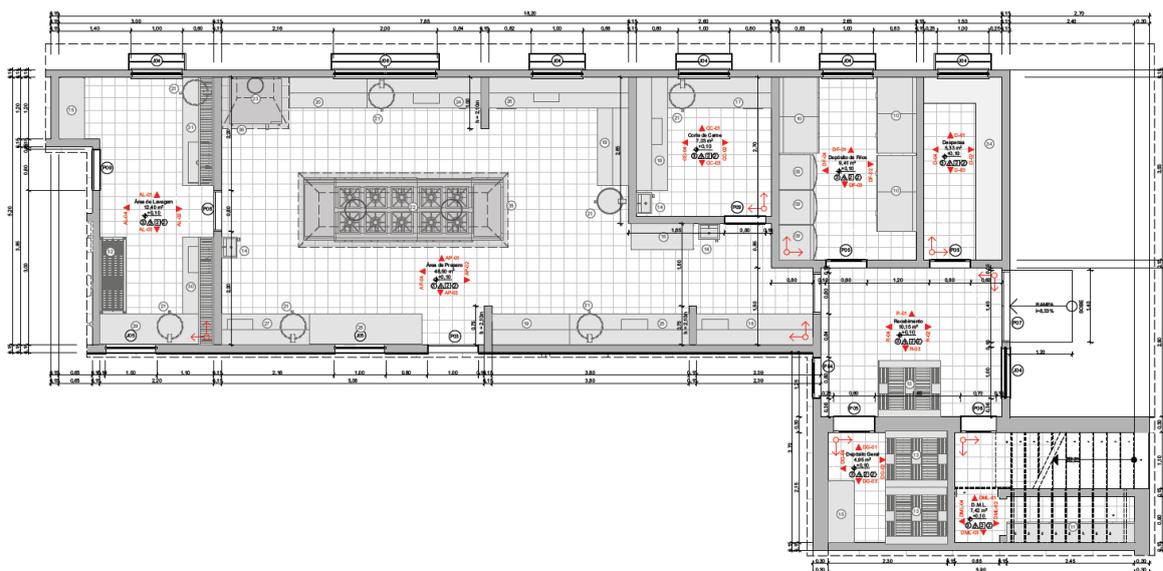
Planta baixa Cozinha IFAM-CMC.
